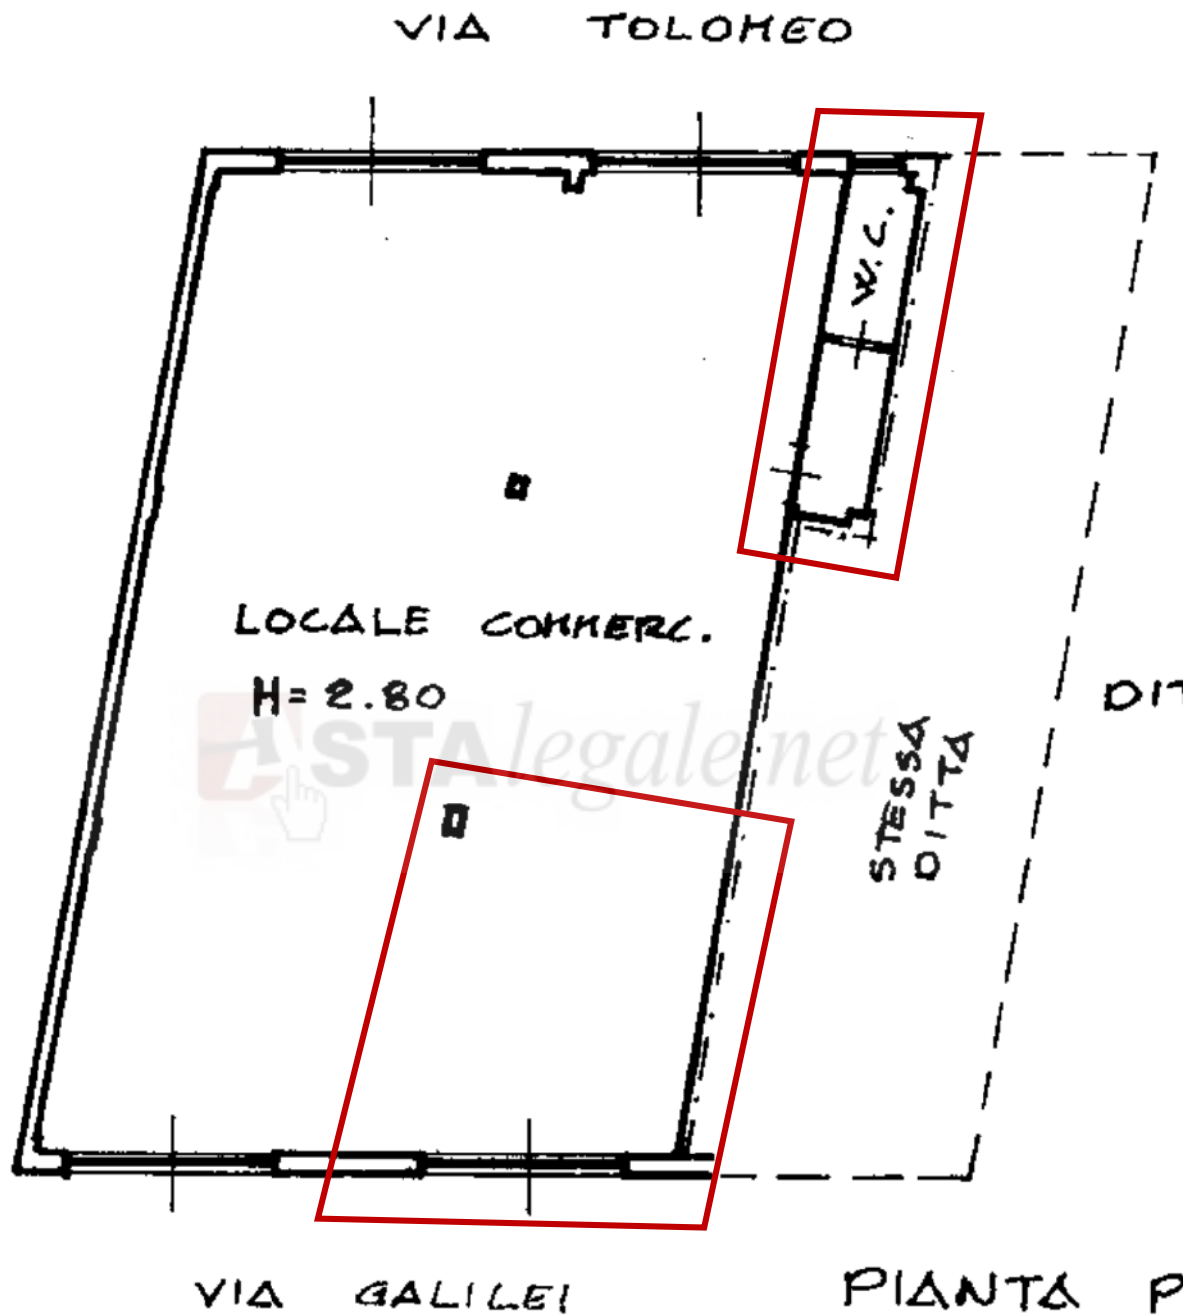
Planimetria Catastale PIANO TERRA - Foglio n°76, Particella n°1598, Sub 3
